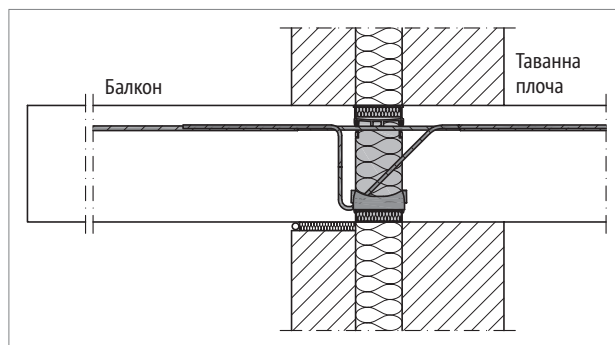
Schöck Isokorb® T mun KL: Свързване при топлоизолационна система
